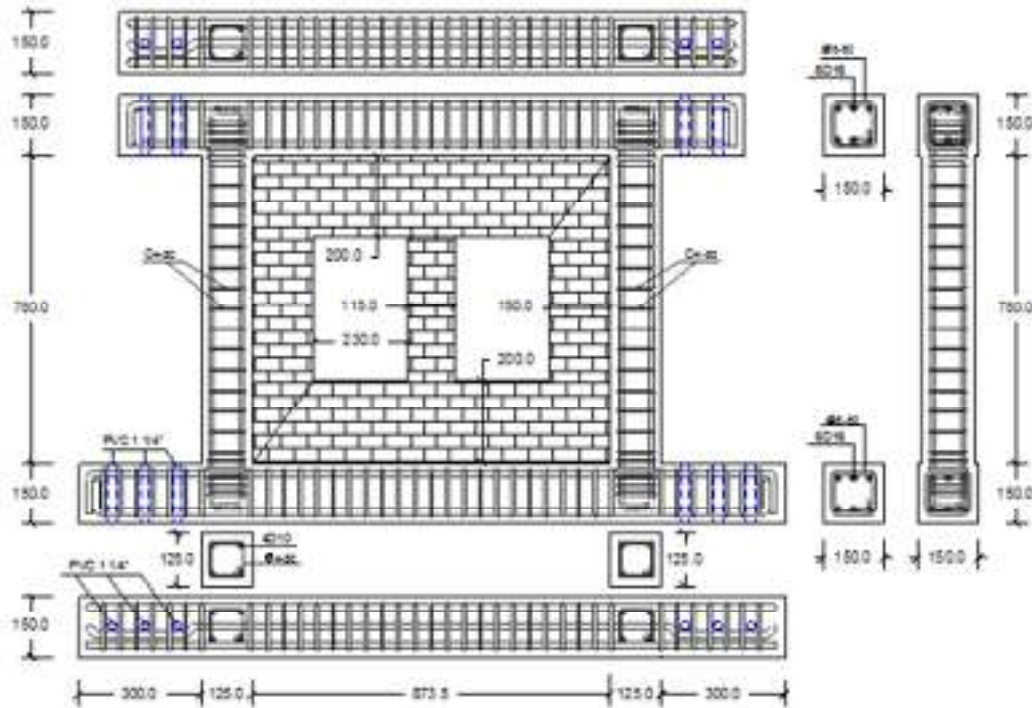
8 Detail penulangan struktur rangka beton bertulang yang diuji
